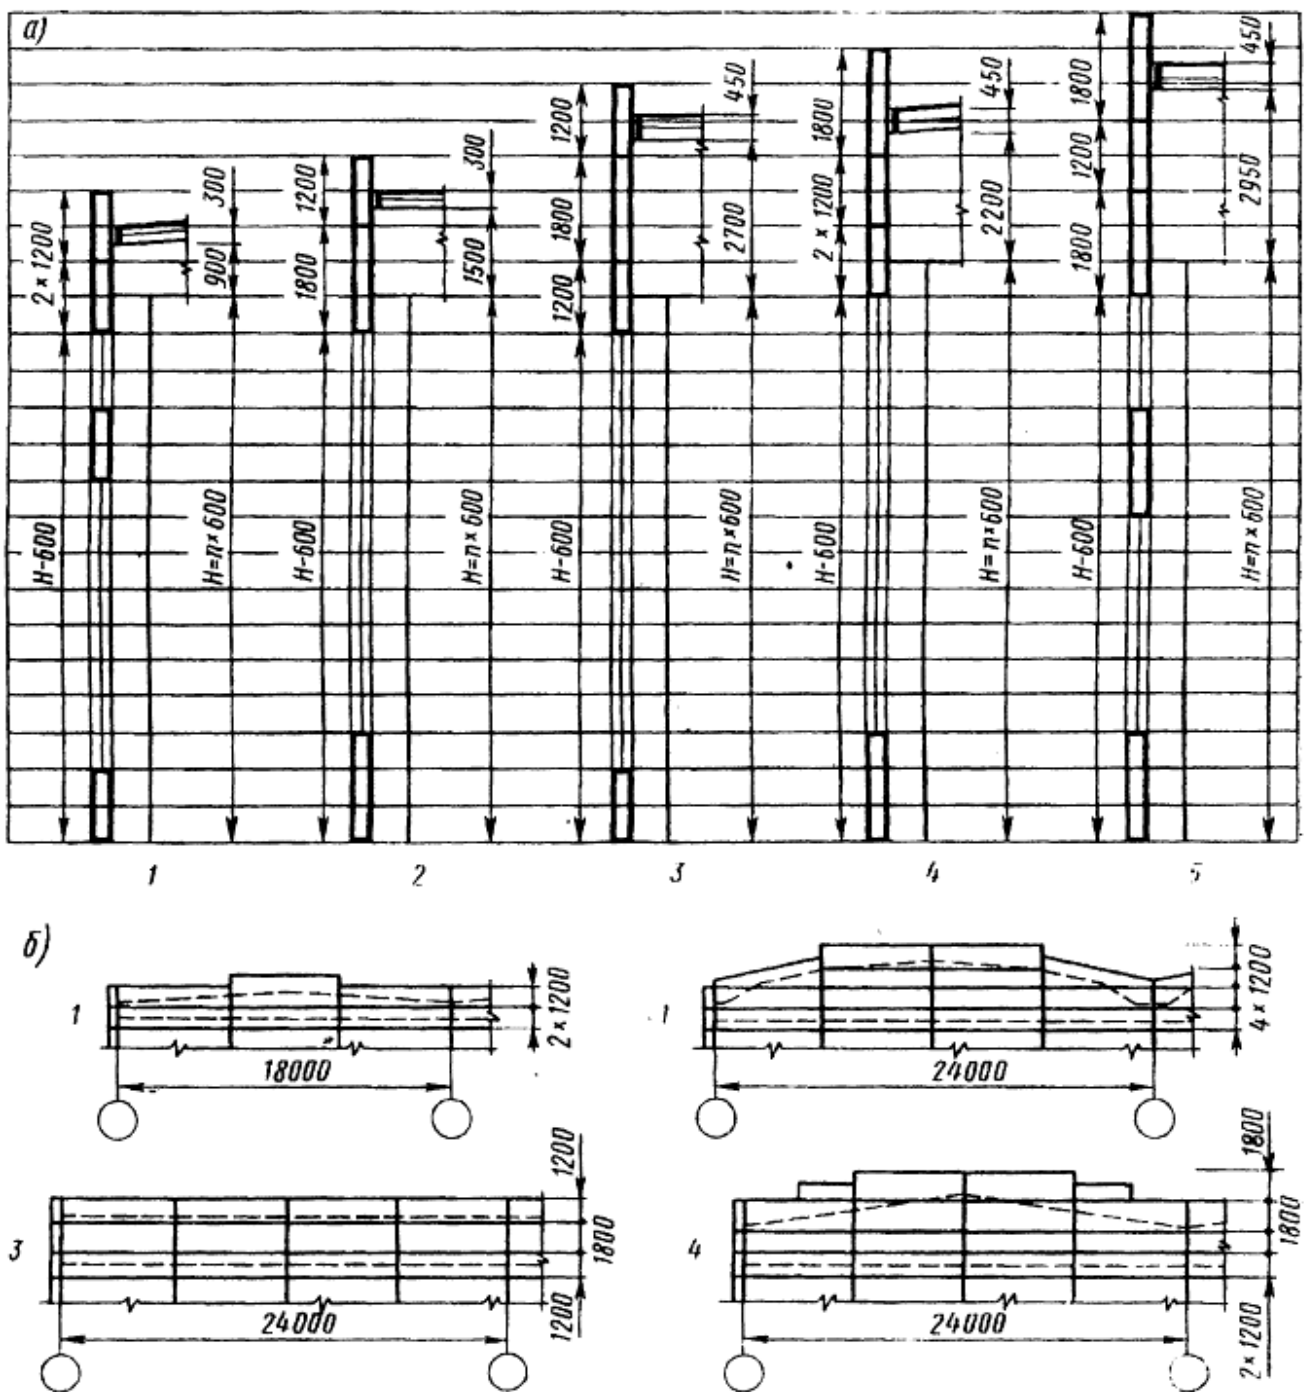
Схеми розкладання панелей у стінах одноповерхових будівель:
